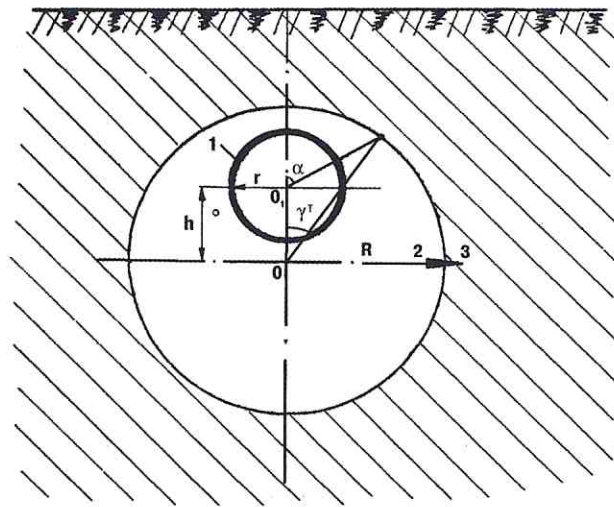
Расчетная схема кругового талика вокруг трубопровода в мерзлом грунте:
